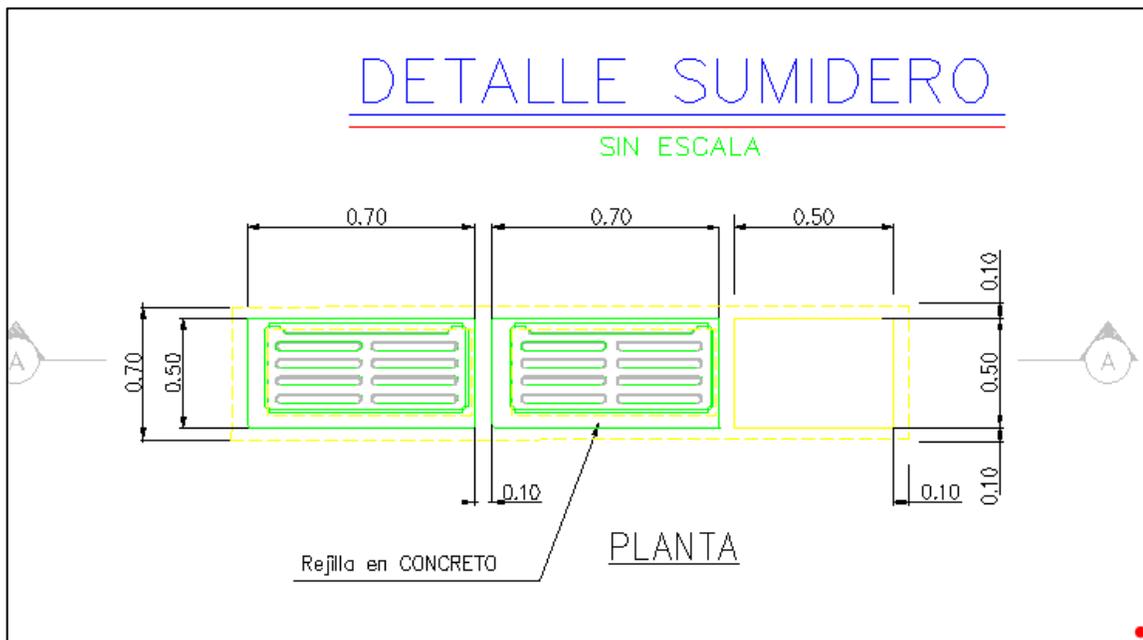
Dibujo en planta, sumidero doble. Fuente: Propia.
